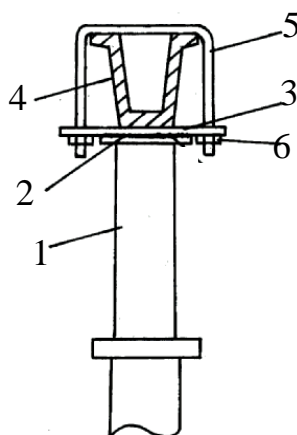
Зажимное приспособление для соединения металлических гидравлических стоек временной крепи усиления с верхняком из СВП: 1 – выдвигающая часть стойки с опорой 2 и приваренной к ней планкой 3; 4 – СВП; 5 – скоба; 6 – гайка
